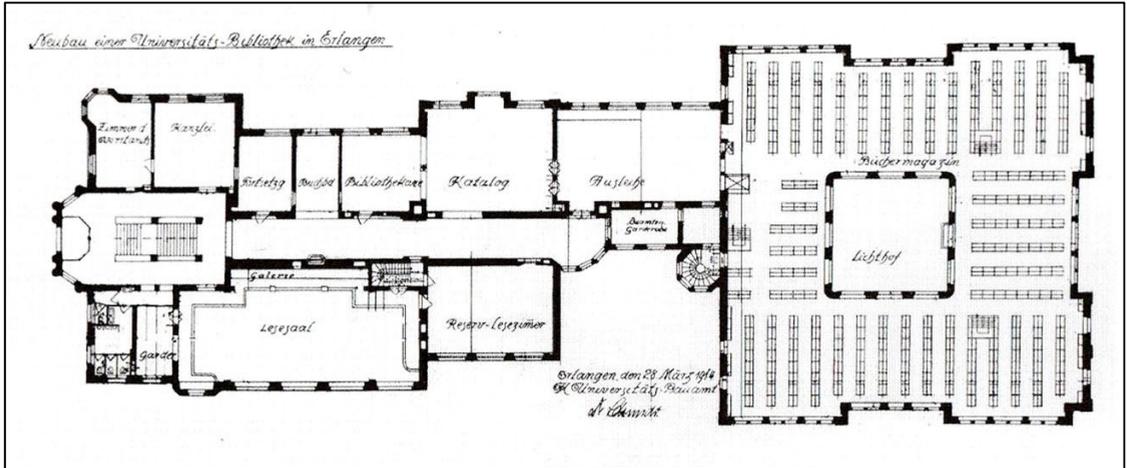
Grundriss des ersten Stockwerks der Universitätsbibliothek mit dem östlichen Verwaltungs- und Benutzertrakt sowie dem westlichen Magazintrakt (aus MAYR & MENGELS 2005).
